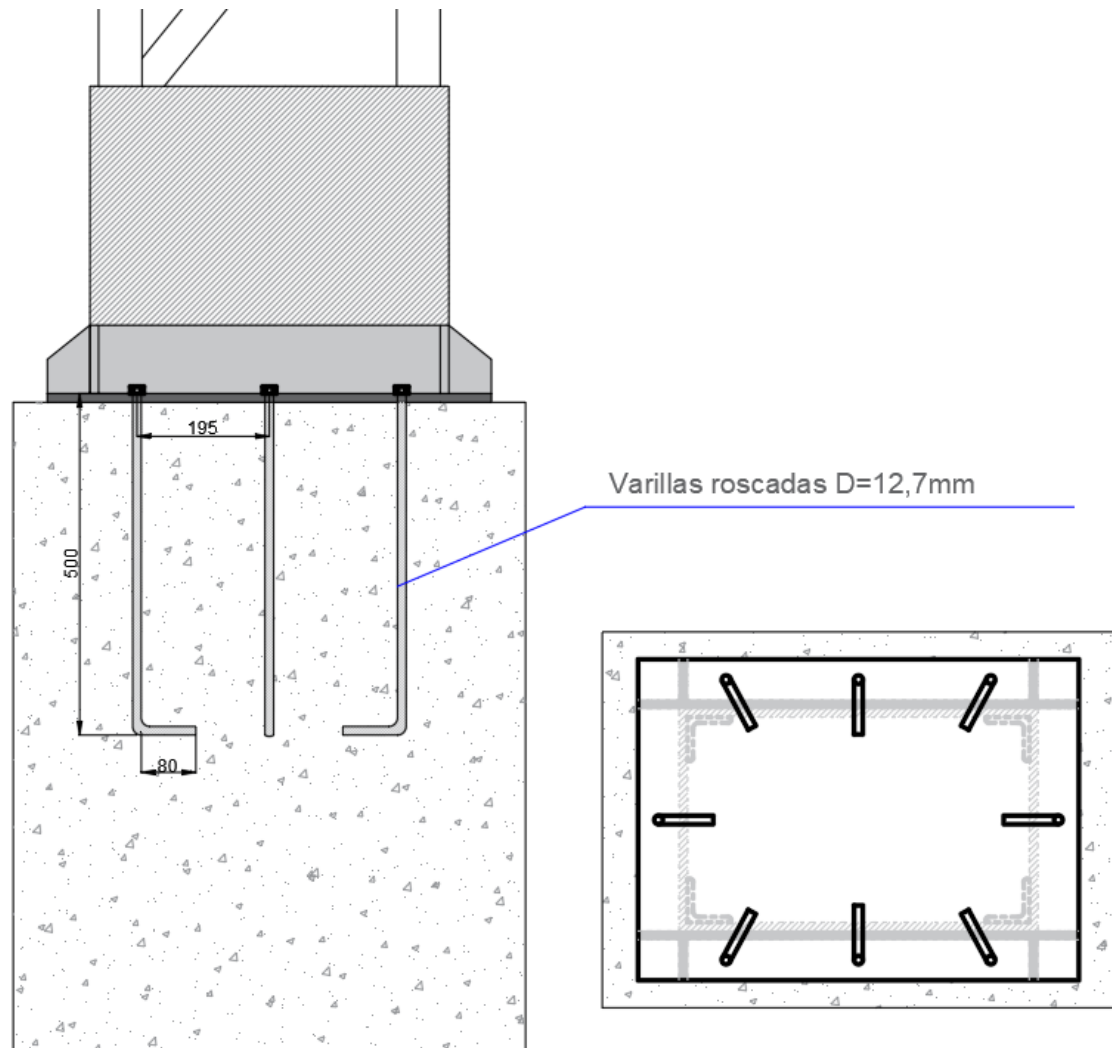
Detalle de anclaje de la placa base al hormigón
